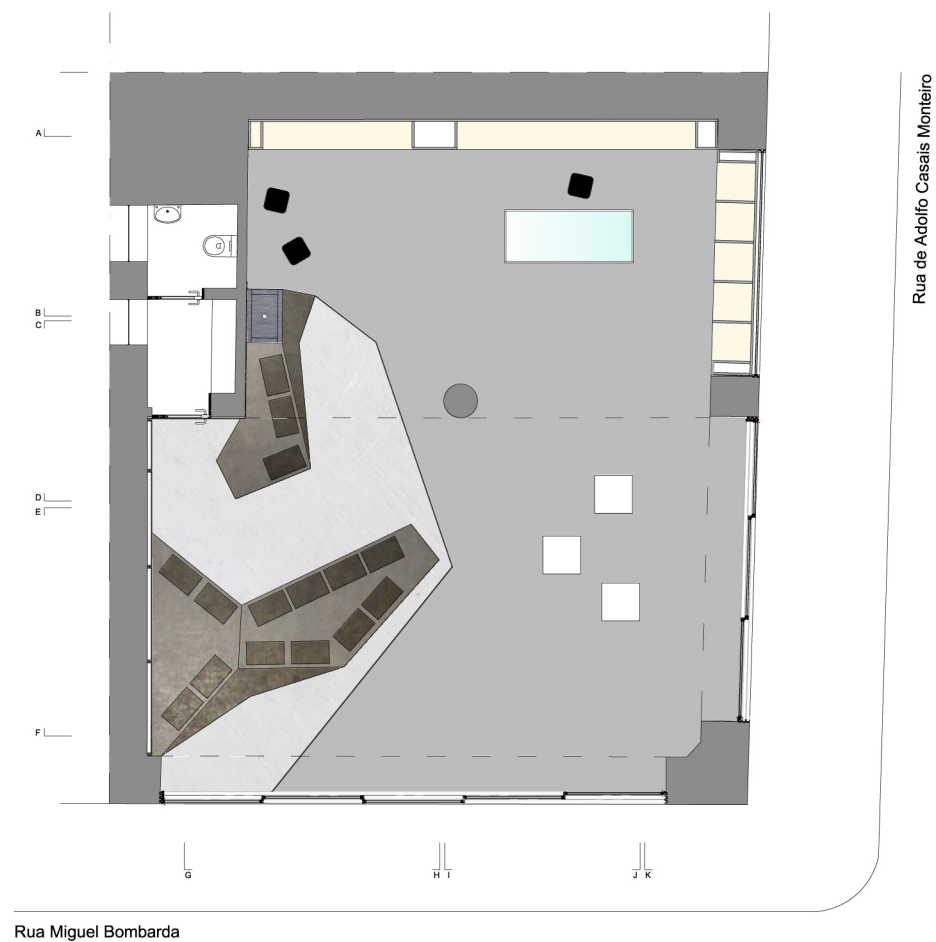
Planta do espaço, à escala 1:100 (à escala 1:20 em anexo)
